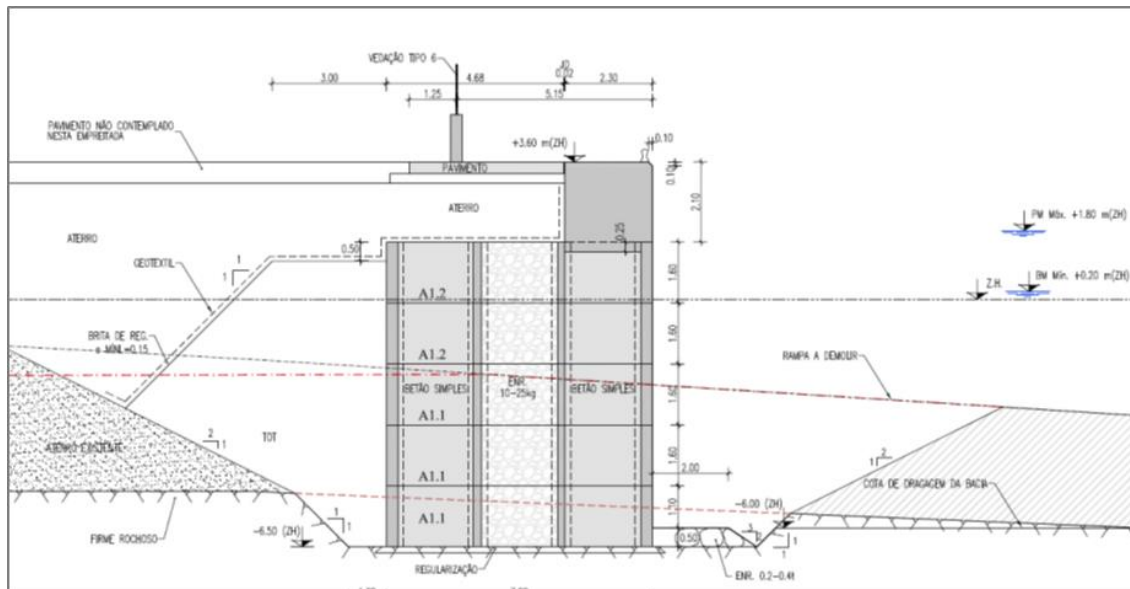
Terraplino - Perfil tipo da retenção poente
